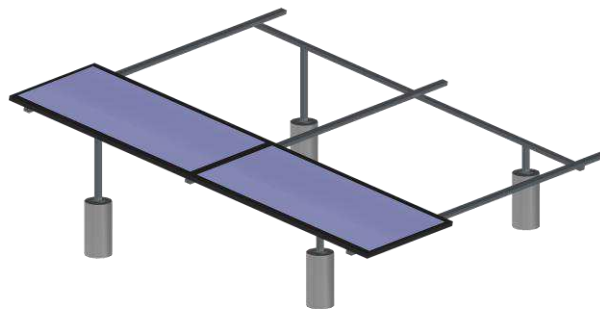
Esquema de Montagem Usando os Suporte para Laje
